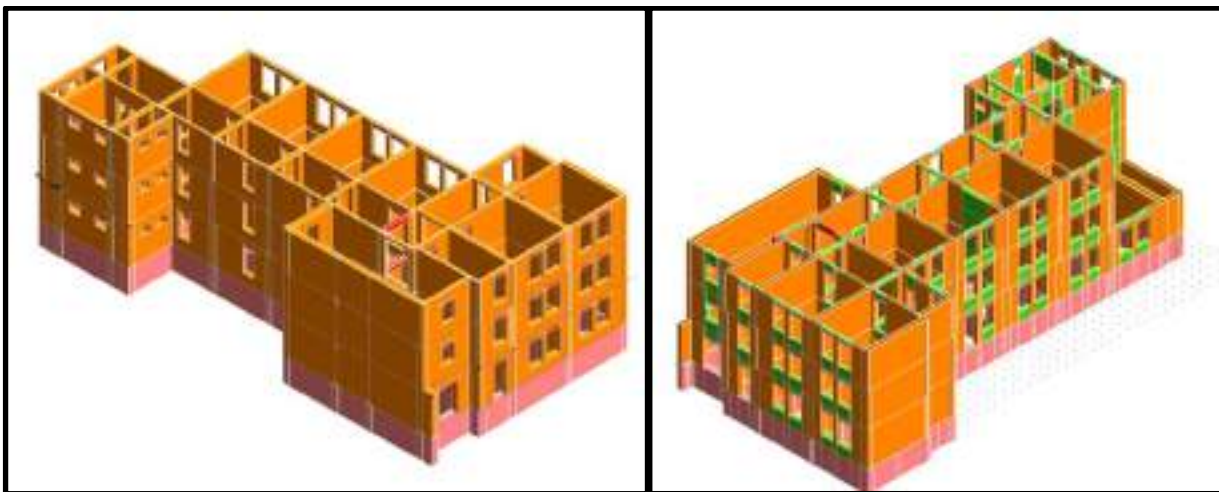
Vista 1 e 2 - Modello geometrico strutturale
